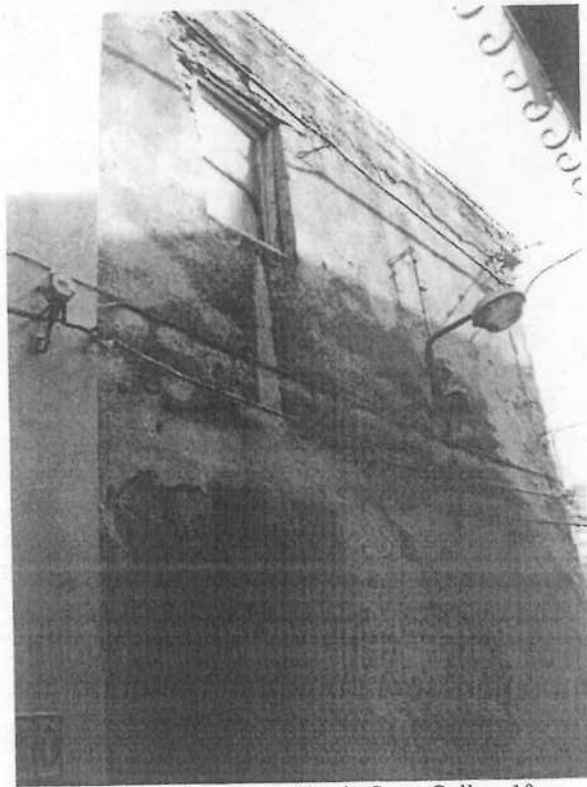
Prospetto sulla via Costa Gullo n.10.
